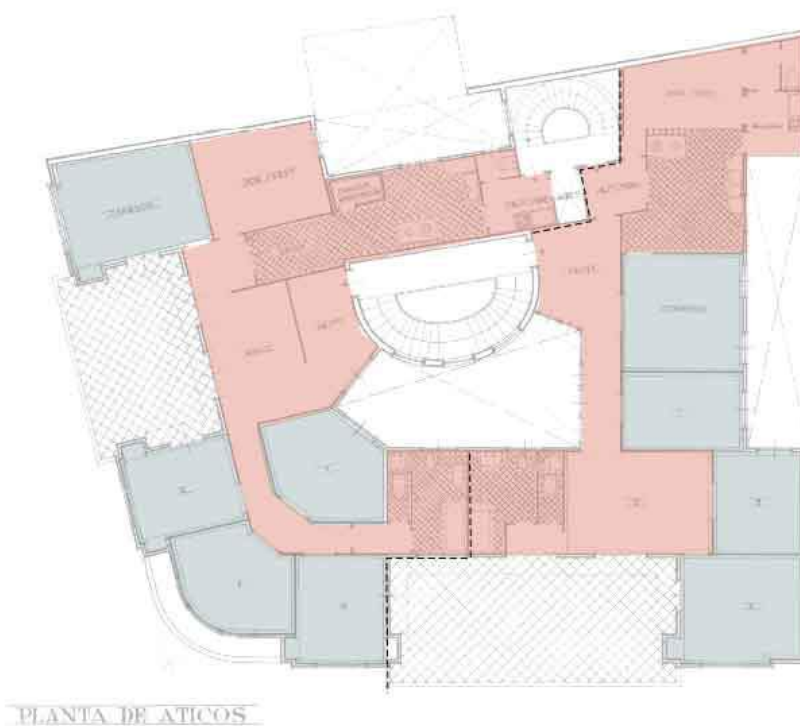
Edificio Legorburo. Planta de áticos. Proyecto original. Tratamiento digital: Javier Cuartero Colmenero.
